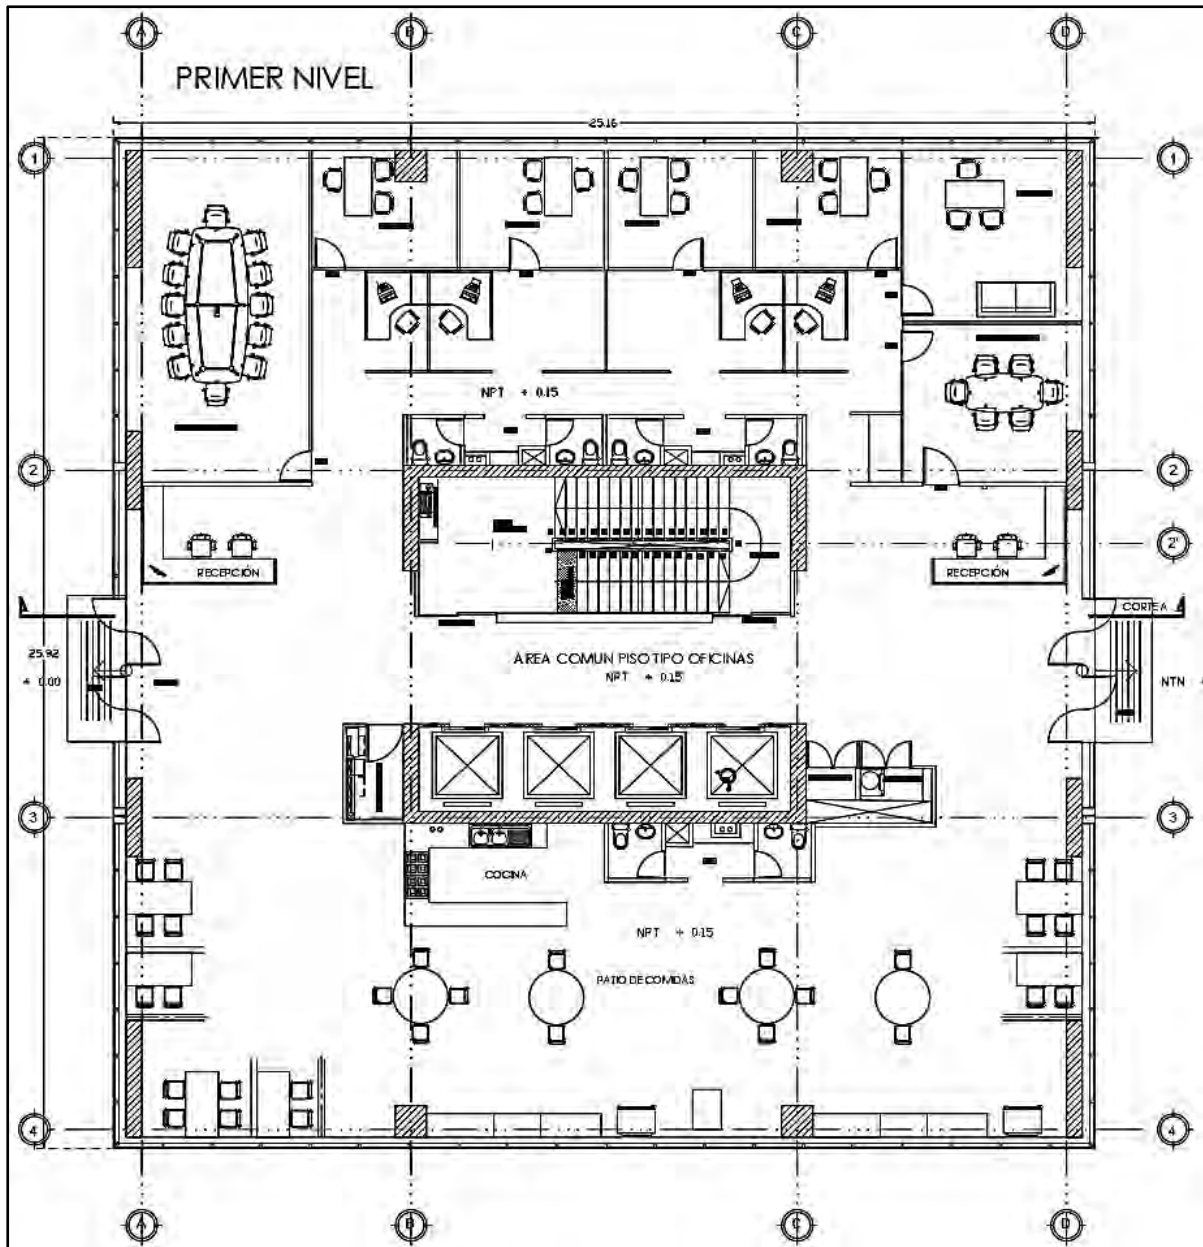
Plano de edificación de la primera planta (Fuente propia)
